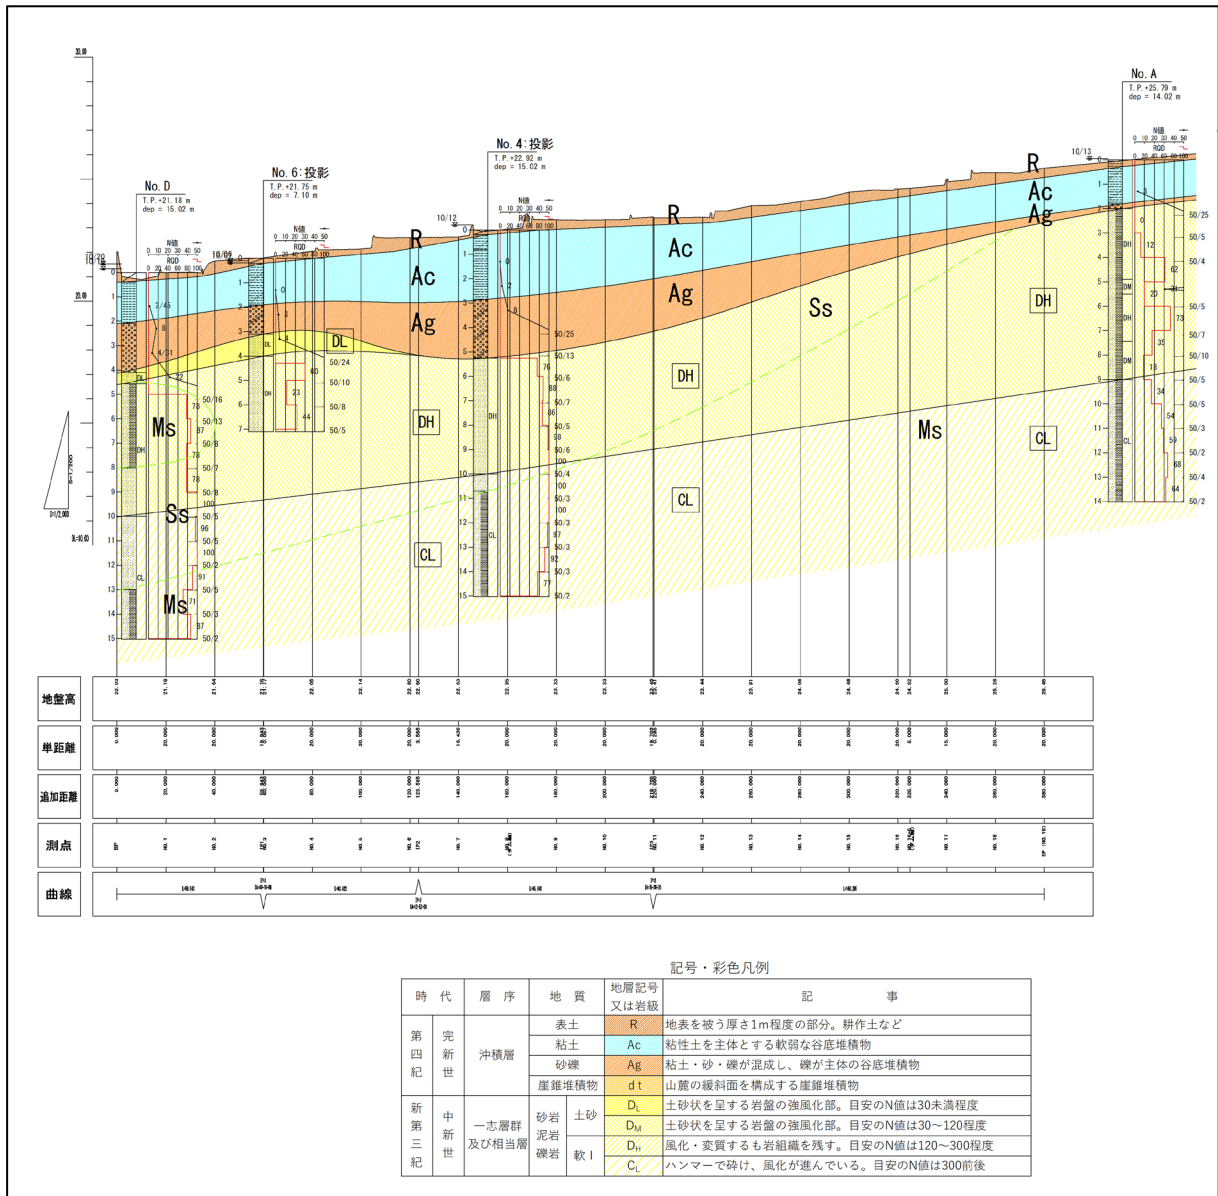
(1) ボーリング調査位置図及び推定地質断面図
